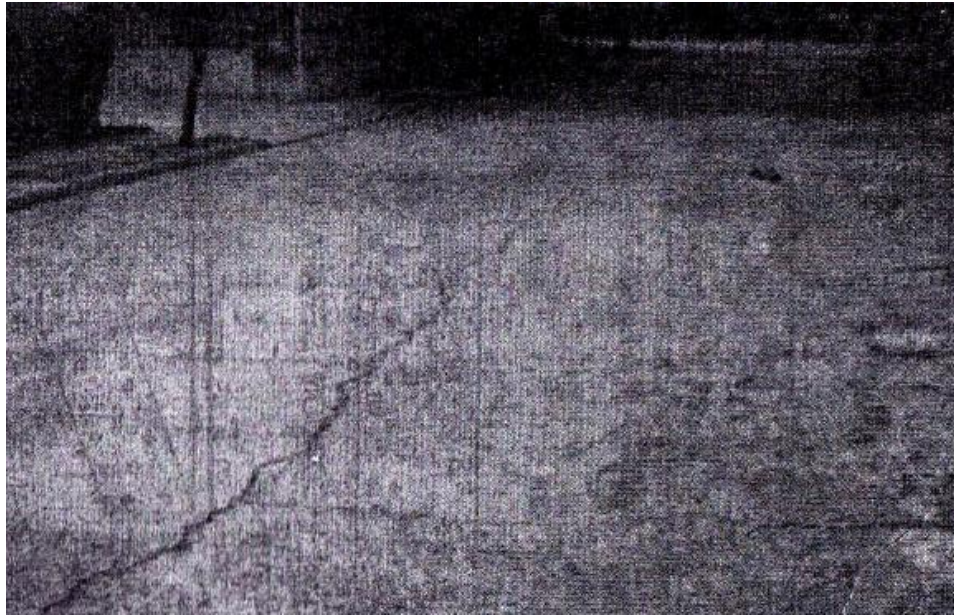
Agrietamiento de un pavimento rígido sin juntas.
